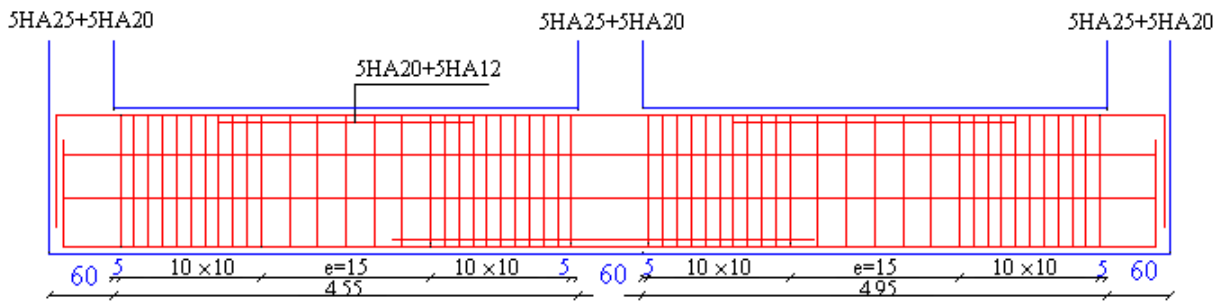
Dispositions constructives des armatures dans la nervure
